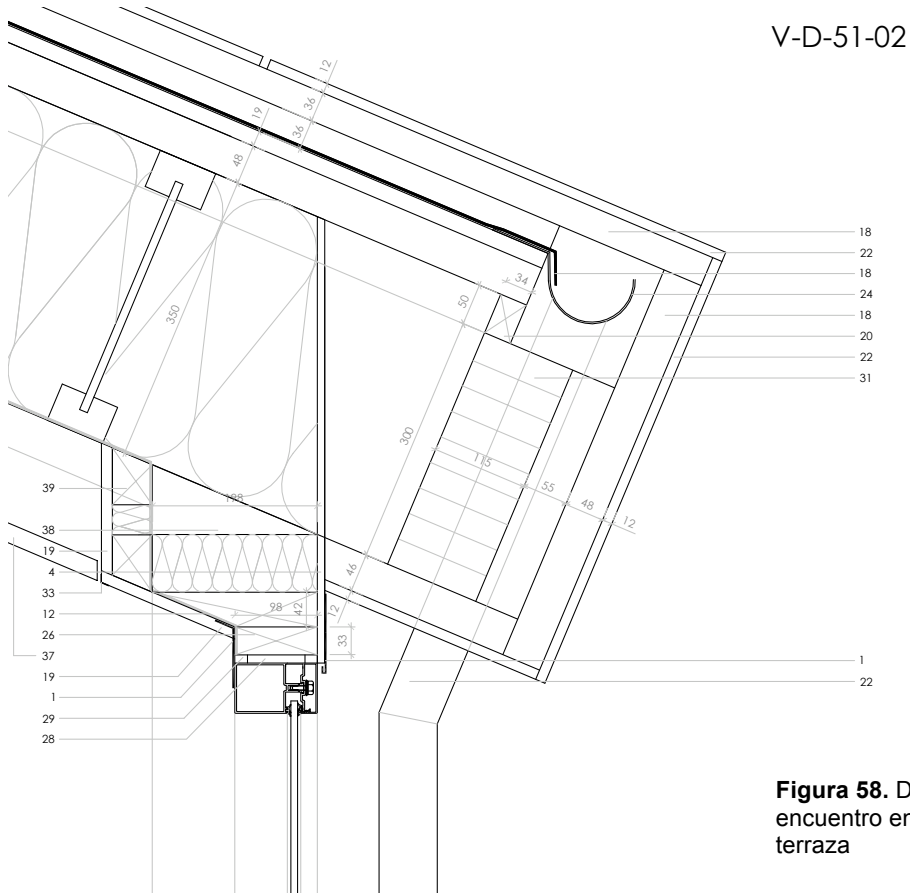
Detalle constructivo del encuentro entre el forjado interior y el de terraza
